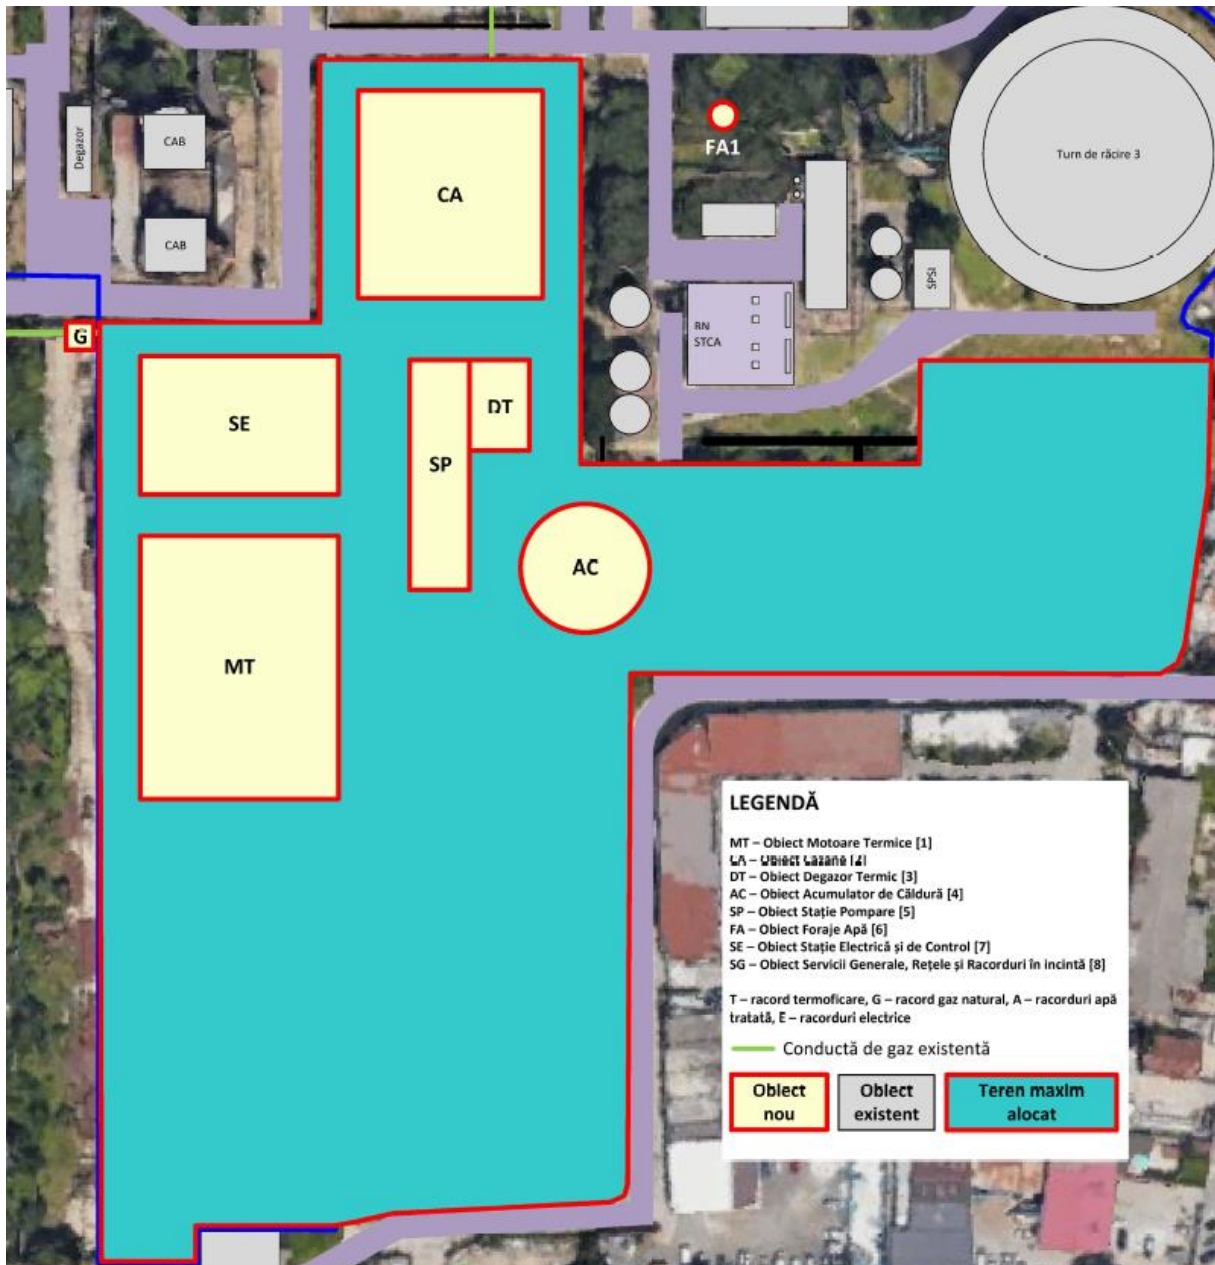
Plan de situație – teren alocat pentru Sursa nouă în CET Palas – etapa 1a+etapa 1b
